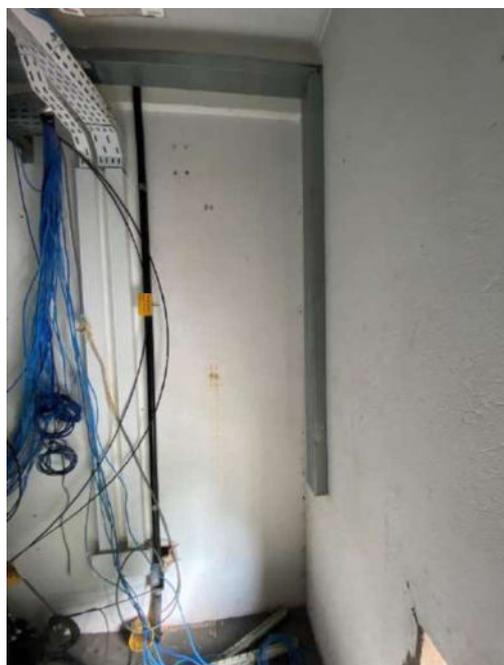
Visão geral - Presença de fissuras na alvenaria
